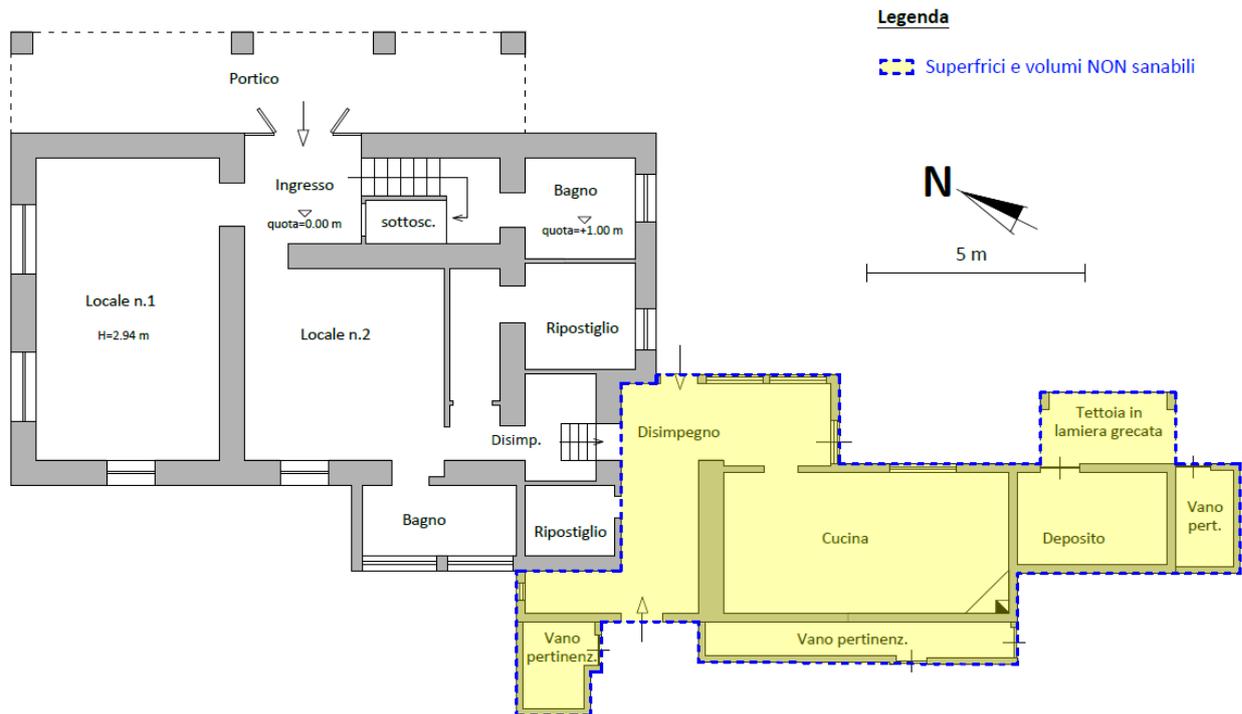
Planimetria dello stato reale dei luoghi - Piano Terra (in giallo le parti non sanabili)
